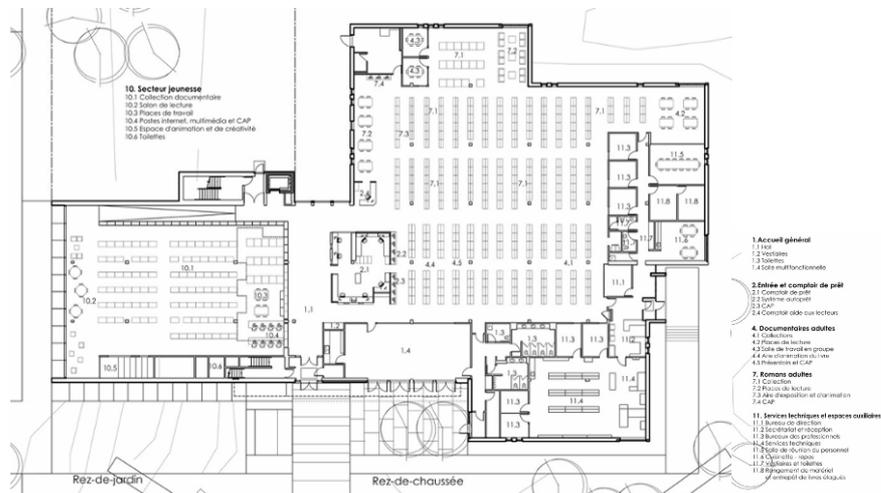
Planta baixa segundo pavimento (Concurso de Projeto, 2010)
